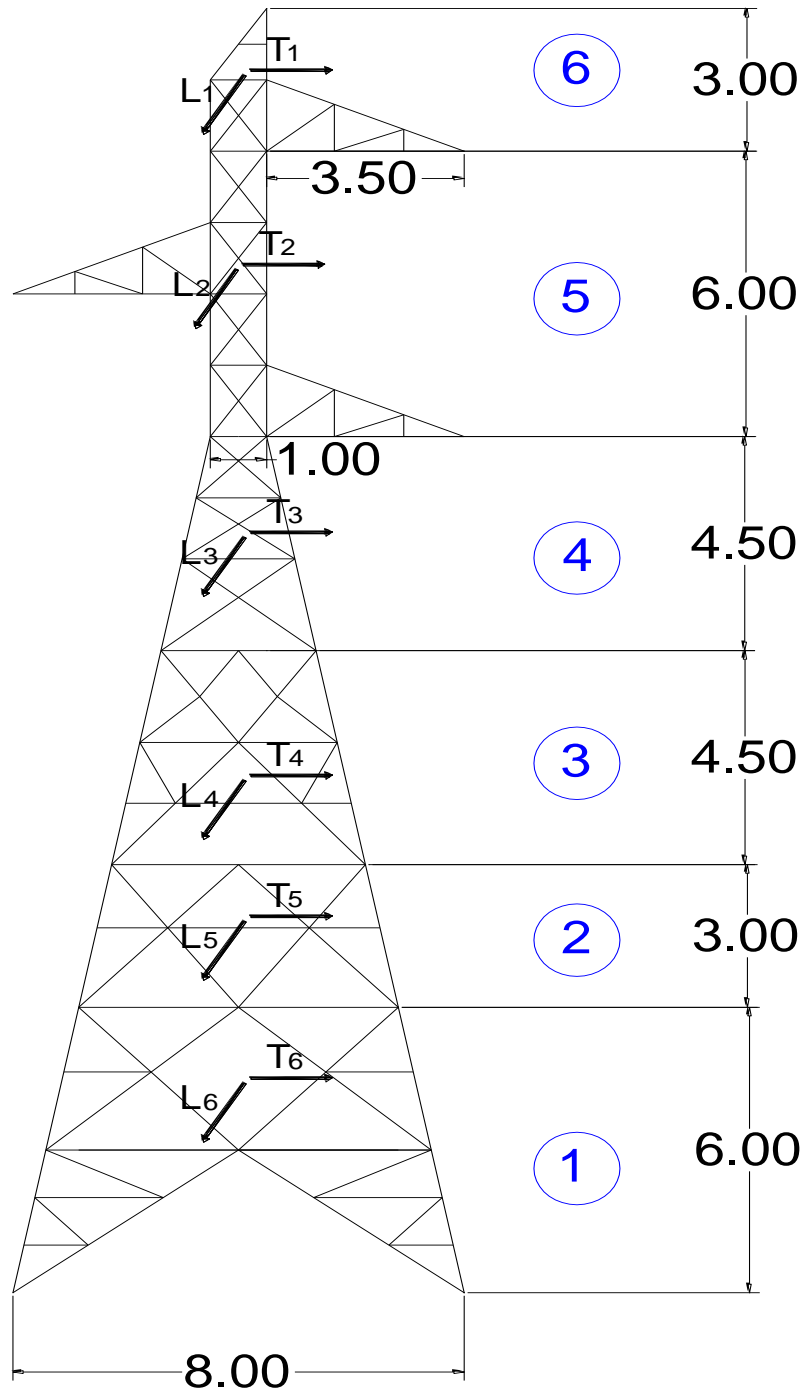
Silueta de la torre longitudinal para el cálculo de viento máximo sobre la estructura (unidades en metros)
